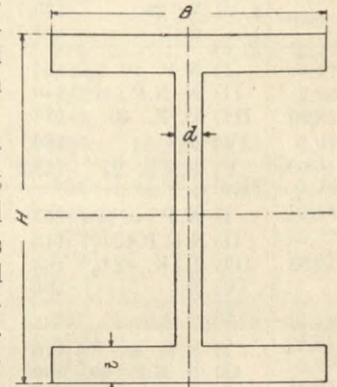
Skizze mit den Bezeichnungen für die Formelentwicklung.
